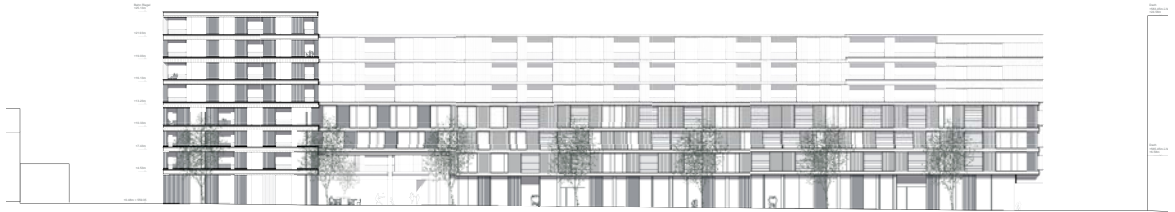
Fassade Freiburgstrasse (Südfassade)
